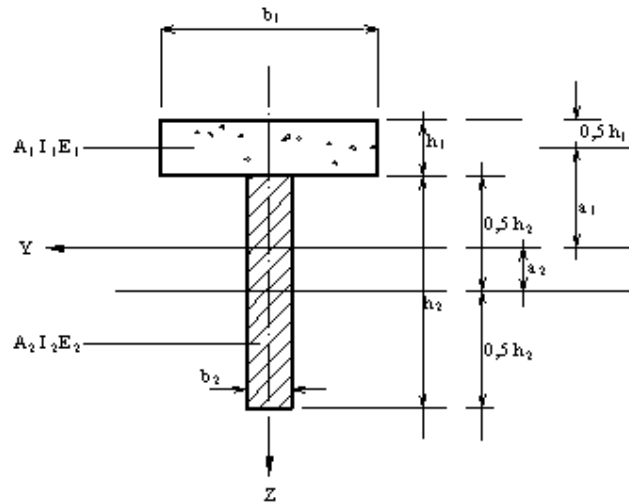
Seção transversal de viga mista madeira/concreto.
